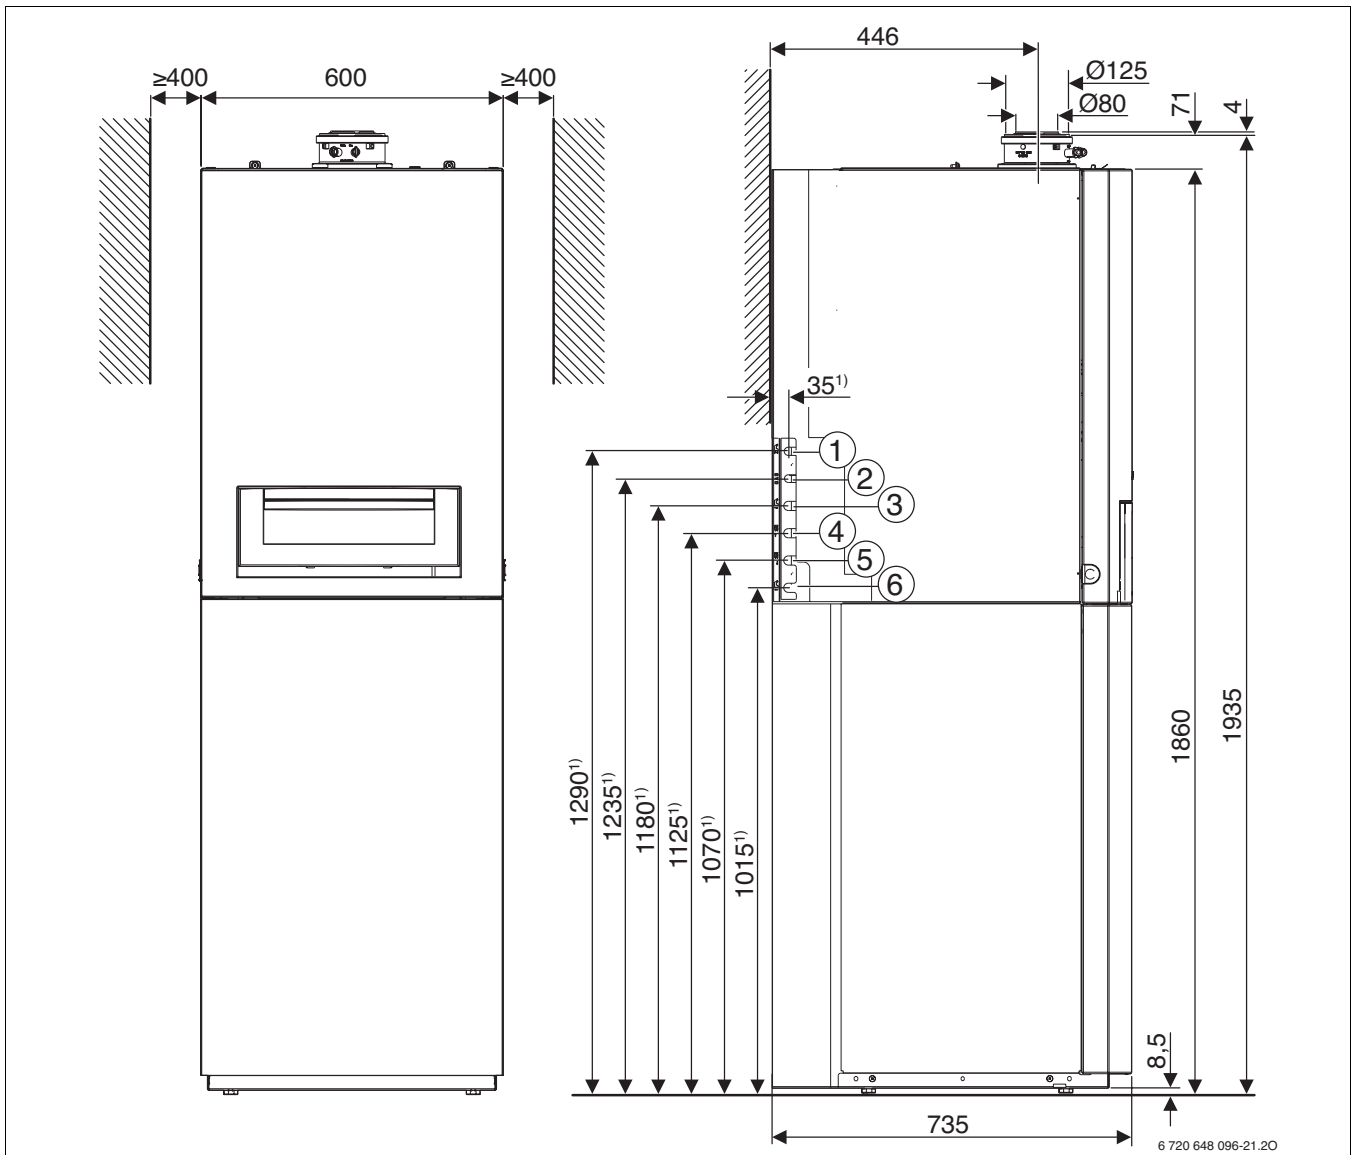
Abmessungen und Anschlüsse für GB172-14/20 T210SR (Maße in mm) mit Seitenblende hinten (Zubehör, inkl. Anschluss-Set seitlich, lang)
